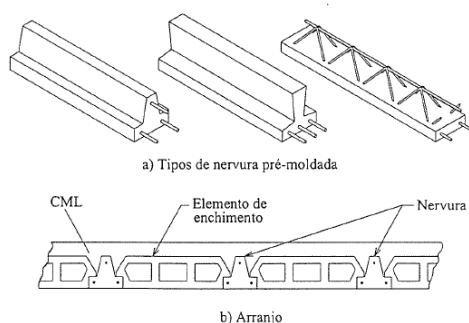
Secções transversais das vigotas e blocos de aligeiramento [6]
